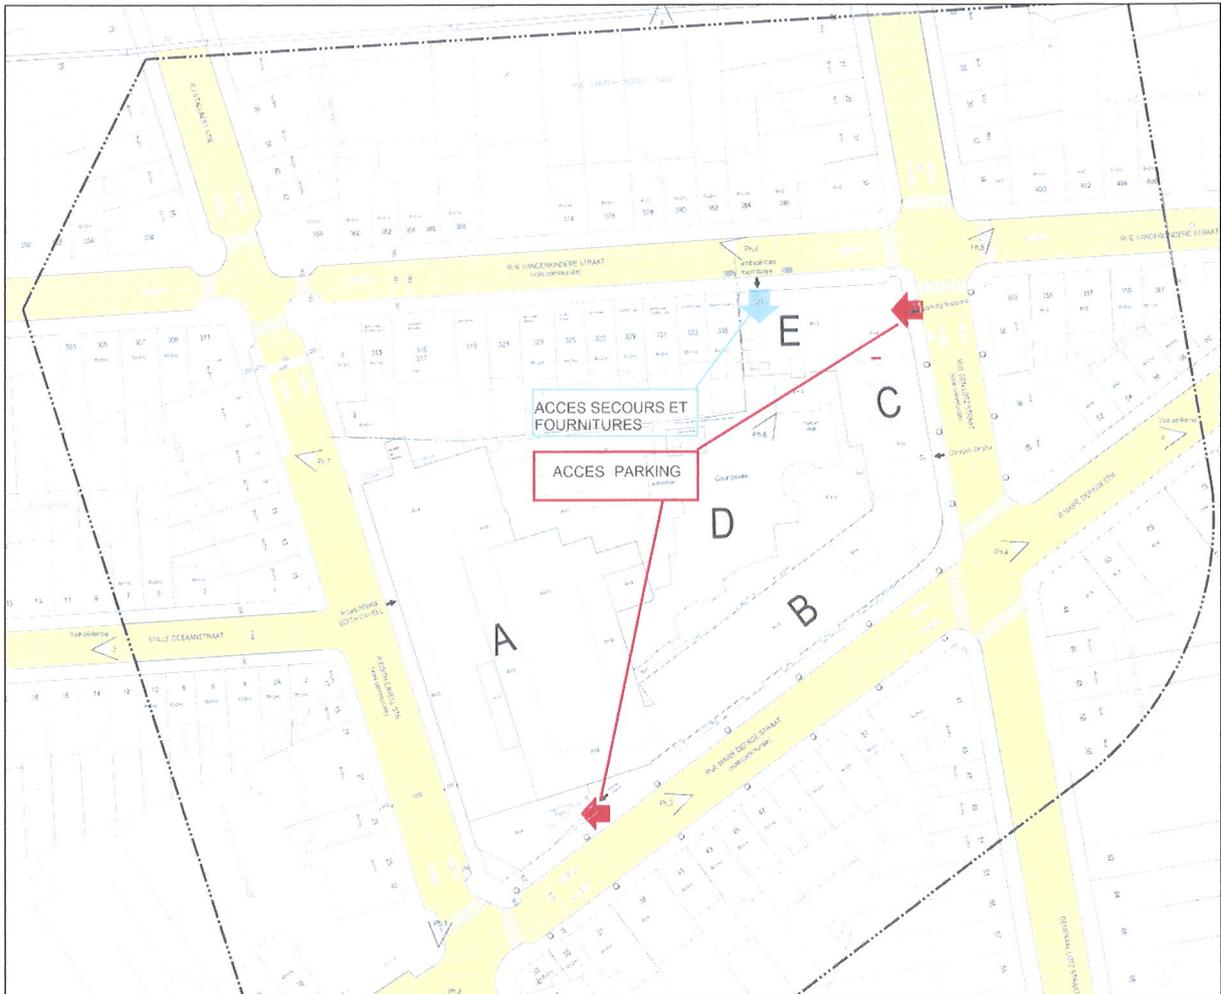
Extrait du plan d'implantation : source : bureau Assar
